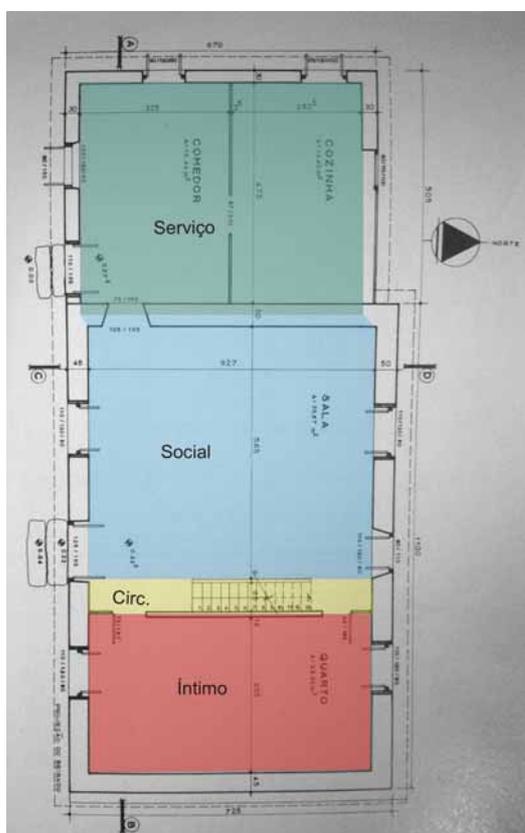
Planta baixa setorizada: pavimento térreo da casa rural da Colônia italiana²⁶⁰ Garibaldi
